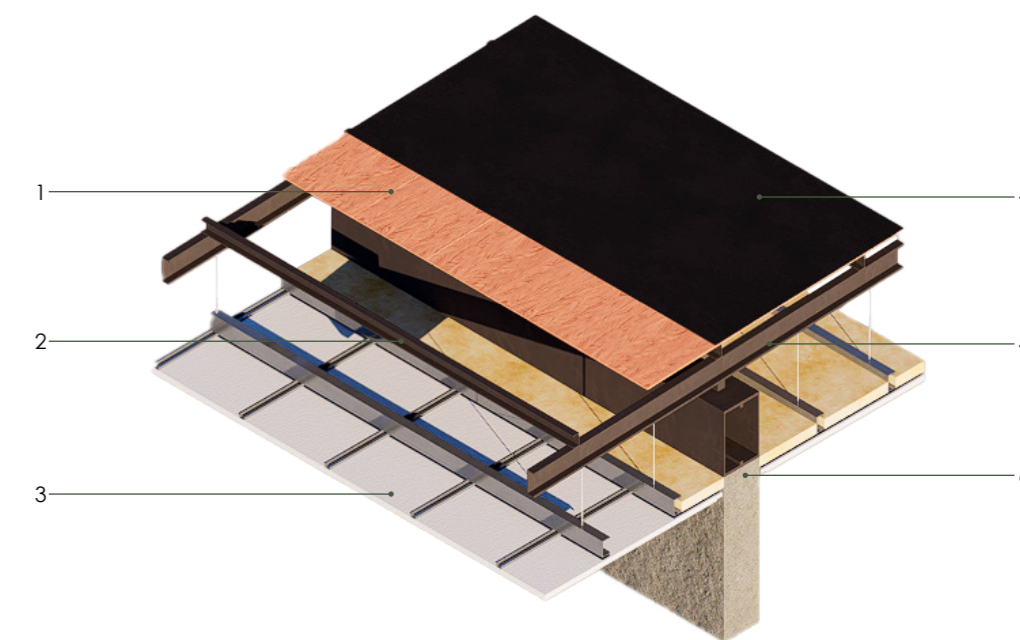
Cubierta con Tablero Plano de Fibrocemento
